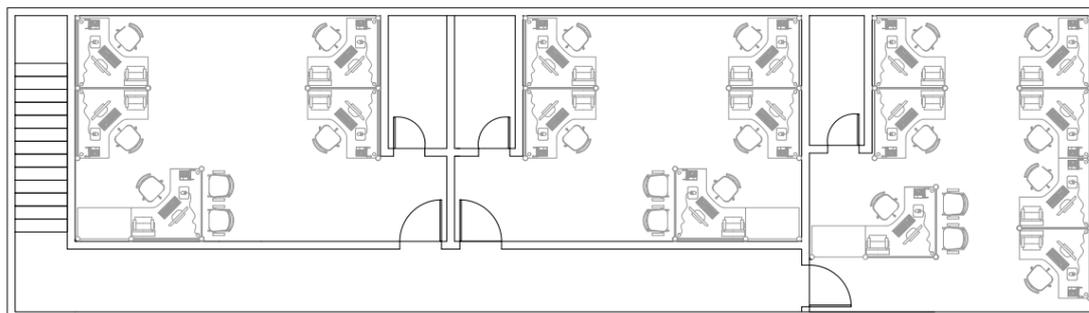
Planta baixa do prédio – Pavimento Superior.
